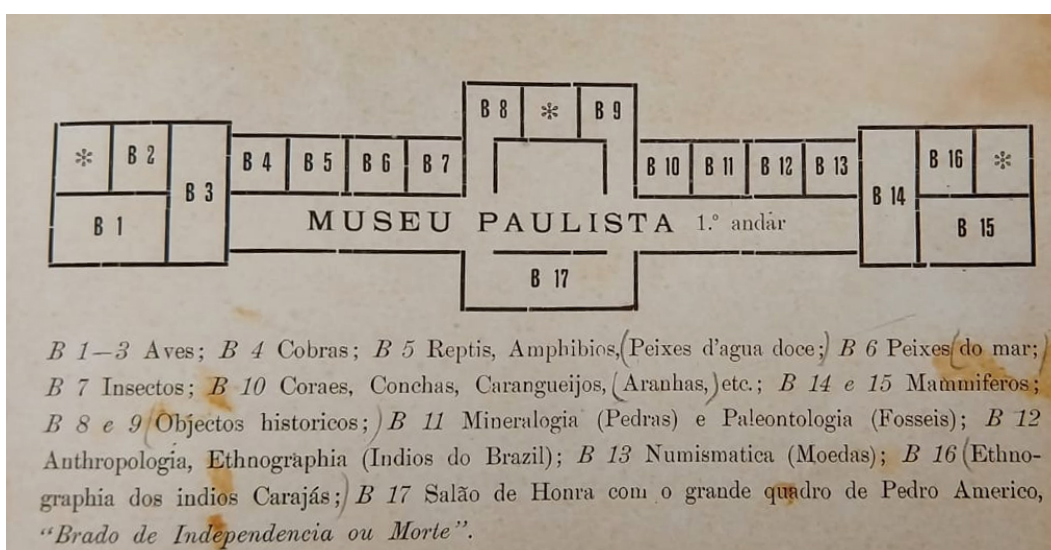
planta baixa Museu Paulista. (GROLA, 2022, p.81)
